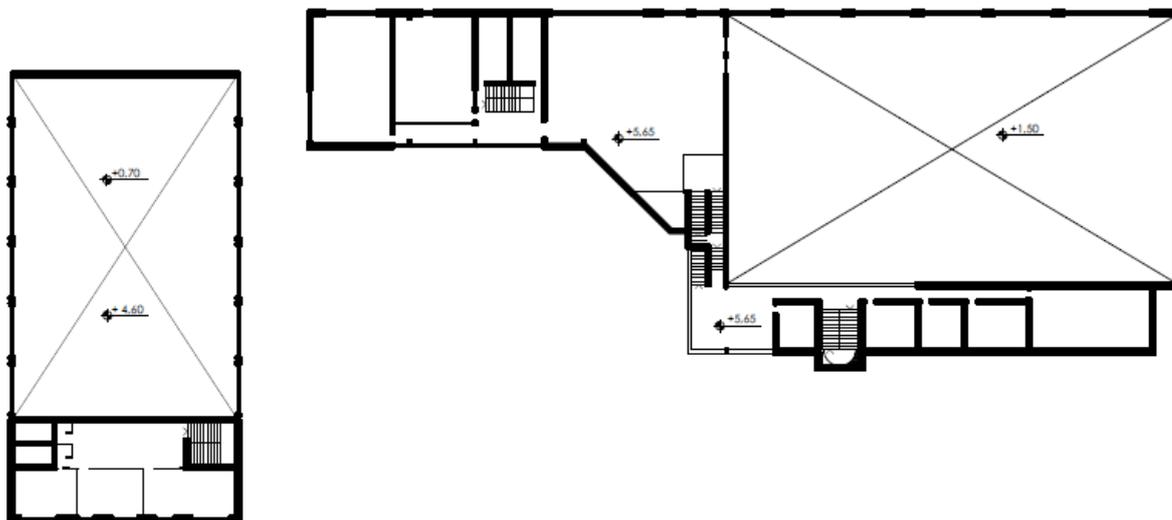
Planta Baixa Antiga - 1º PAVIMENTO. Fonte: produzido pela Autora.
